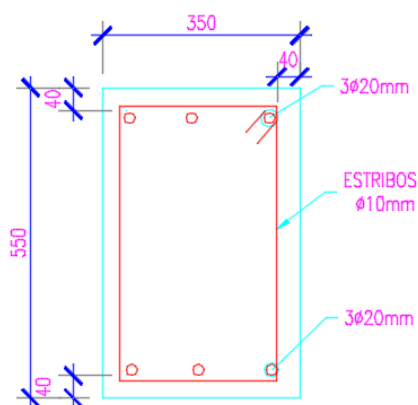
Sección viga secundaria planta terraza o sexta planta.
